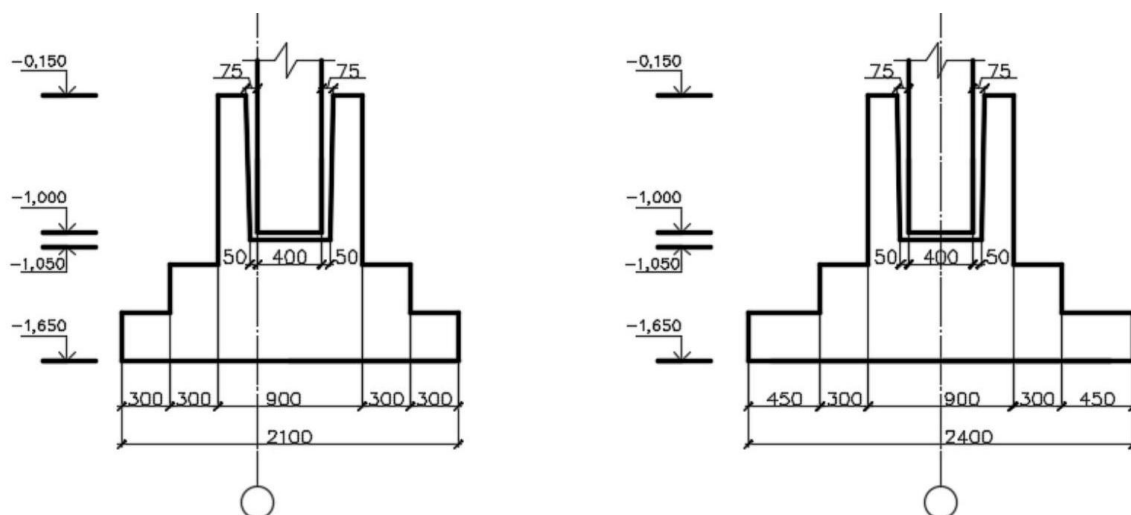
Схема з позначеннями розмірів фундаментів
